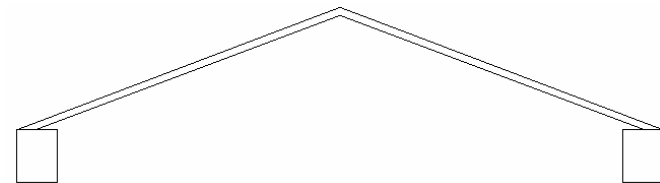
Cubierta inestable sin viga de soporte. Fuente: Autores de proyecto.
